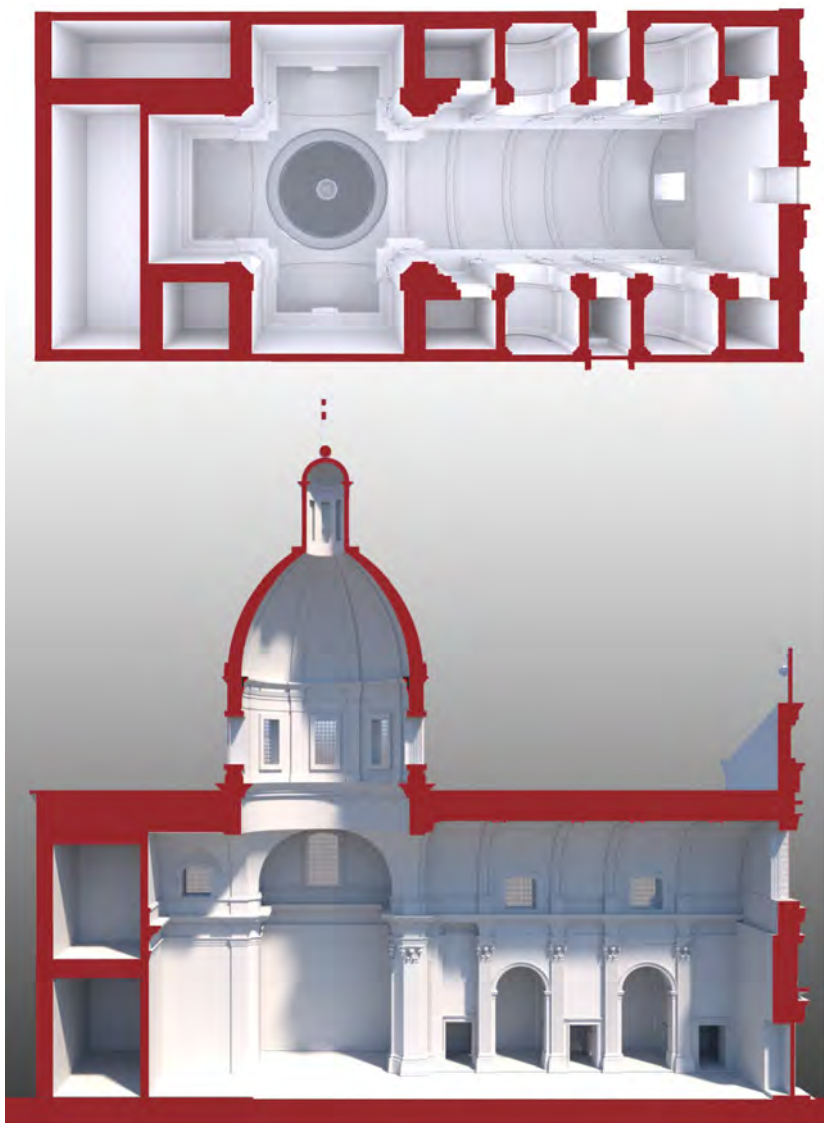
La chiesa di progetto: pianta con prospettiva a quadro orizzontale dal basso; sezione prospettica longitudinale (elaborazione grafica di Andrea Ruggieri).
